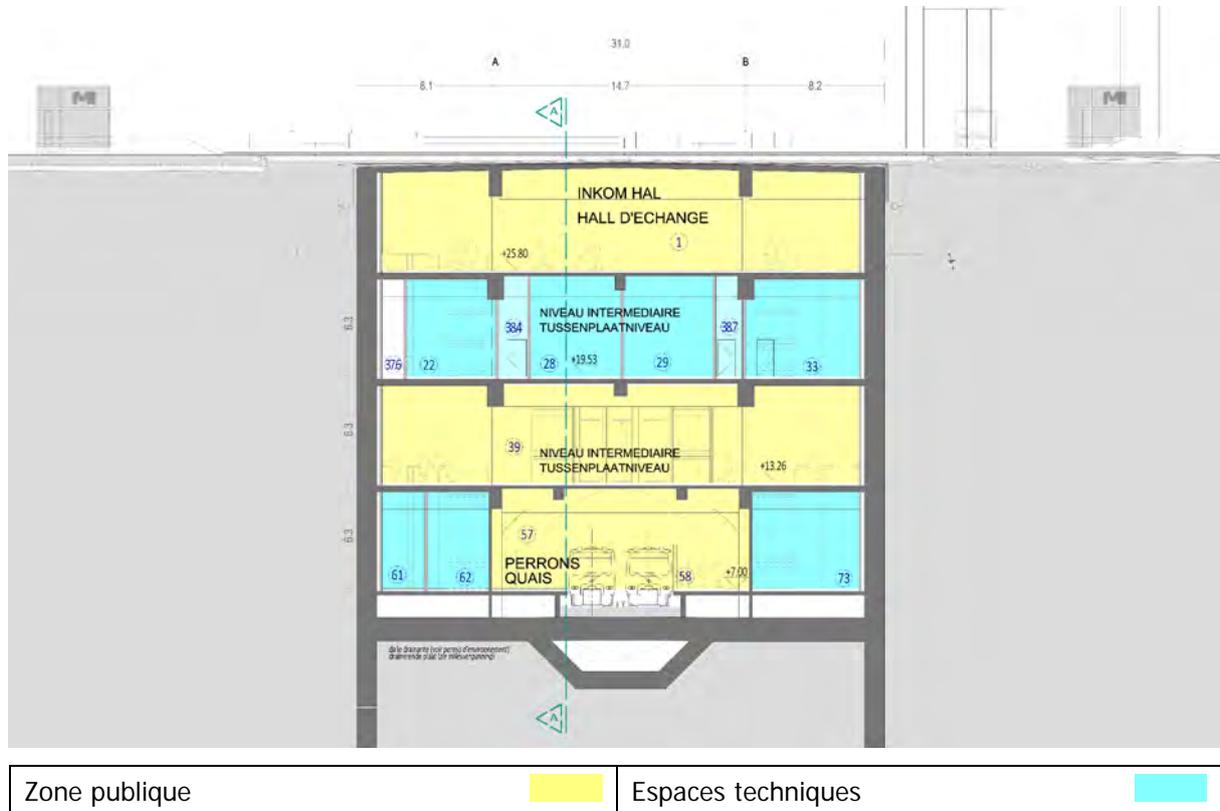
Station Colignon, coupe transversale (BMN, 2018)
